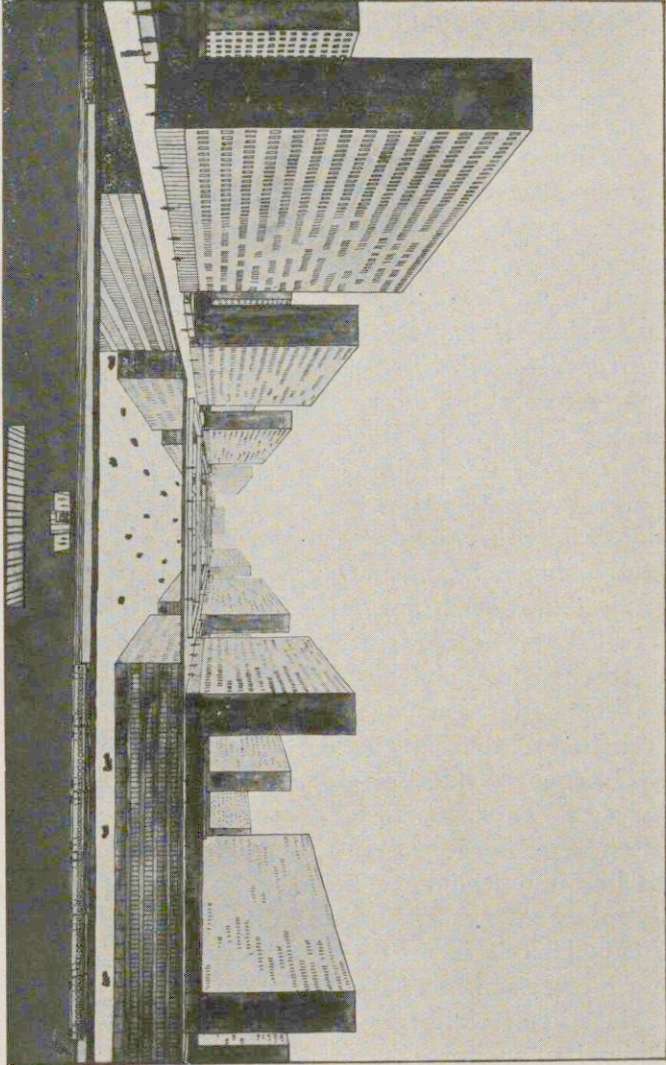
Schema einer Hochhausstadt. Nord-Südstraße
